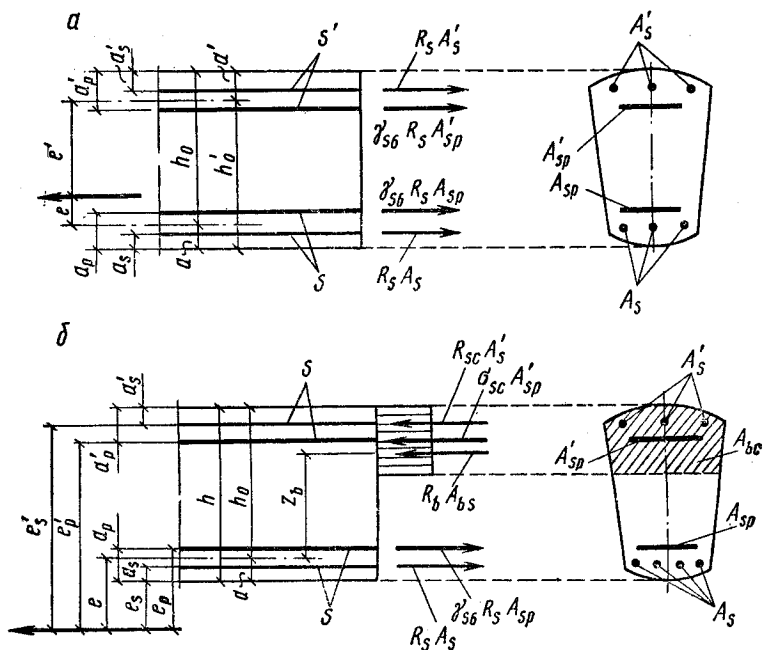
Расчетные схемы внецентренно растянутых элементов; продольная растягивающая сила N расположена
